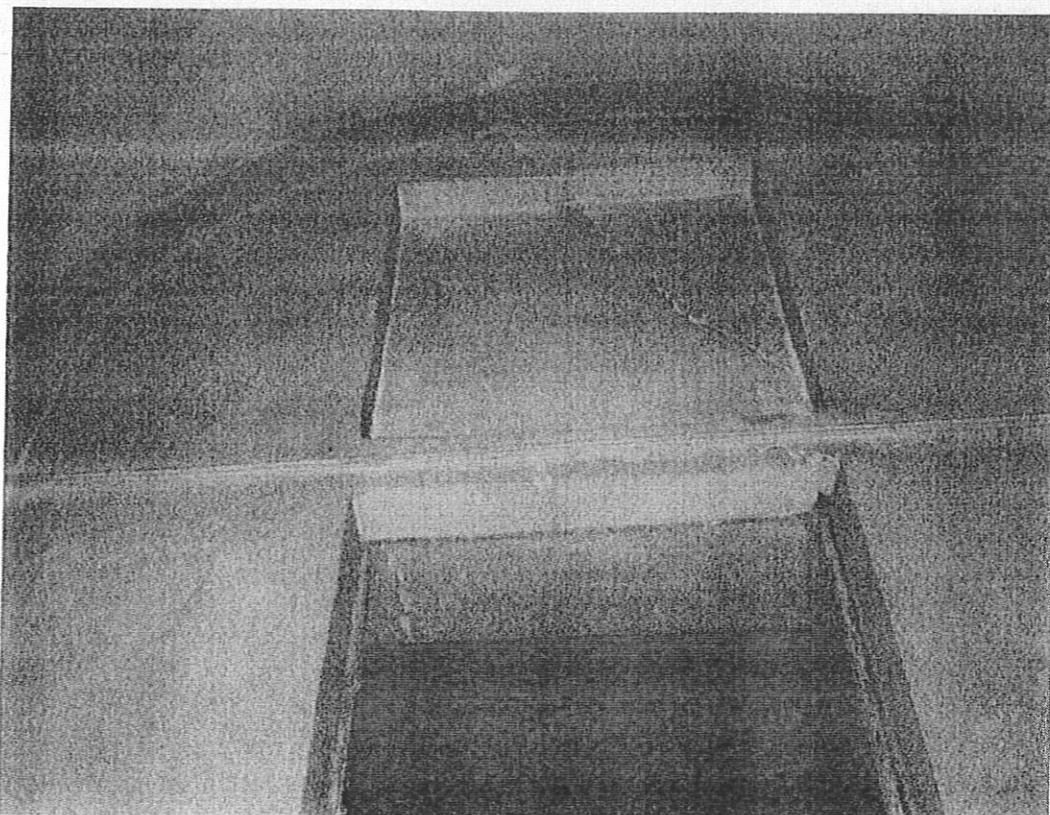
Fessura sul muro di spina della manica su V. Lobetto (07.07.2015)
